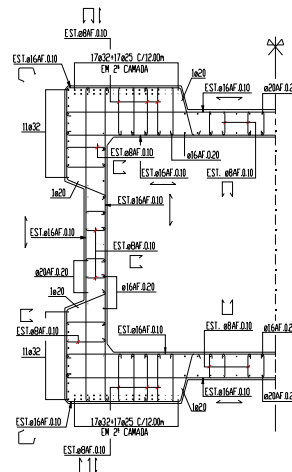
Armadura longitudinal e transversal dos pilares P7 e P8.
